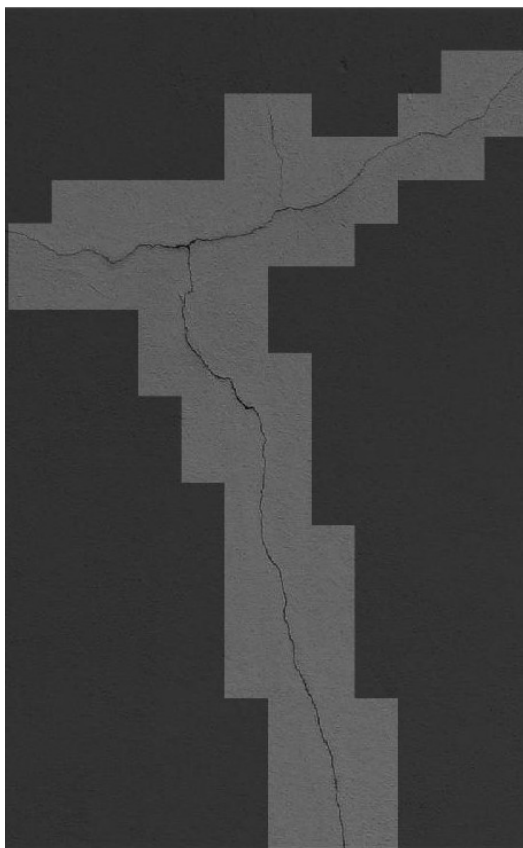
Detecção Fissura Z.F.08
